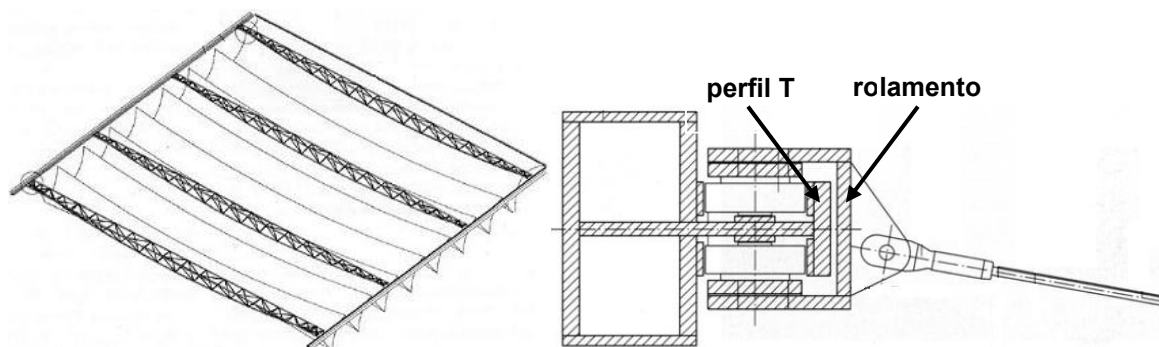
Estrutura da cobertura formada por vigas longitudinais e transversais; rolamento axial e radial (fixado nas vigas transversais) que se movimenta ao longo de um perfil T (fixado nas vigas longitudinais) (WALTER, 2006).
